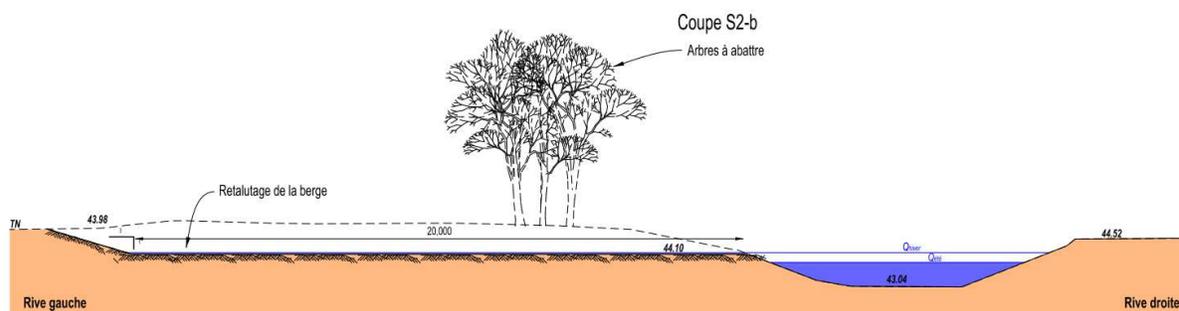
risberme du secteur 2 (Coupe S2-b, plan n°13)
